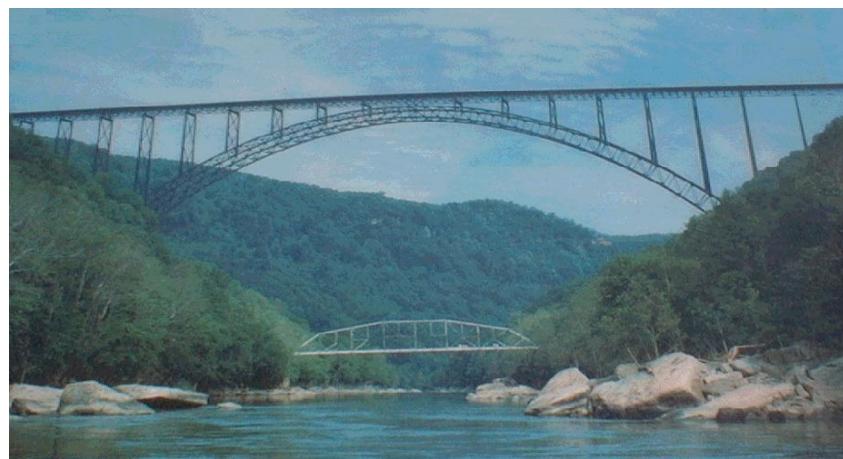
So sánh sự làm việc sơ đồ cầu vòm và dàn
